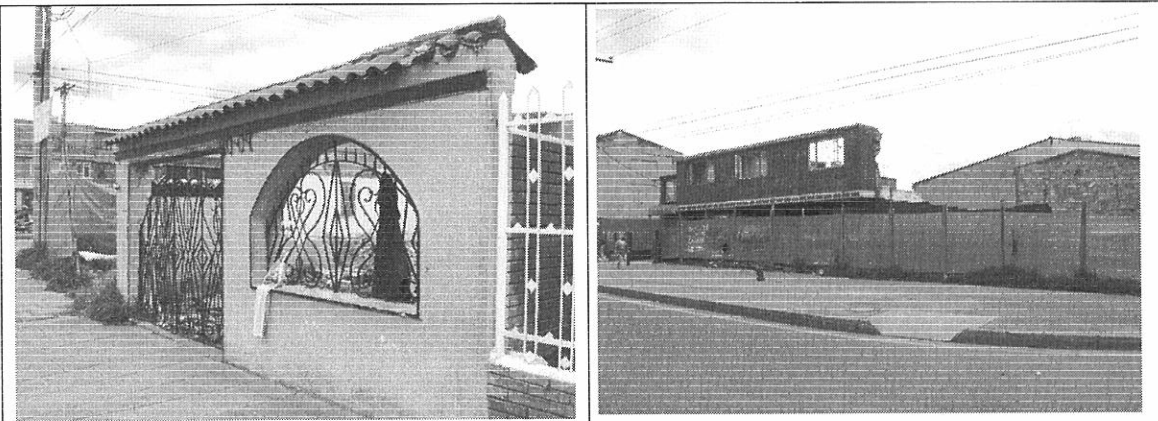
Fachada de la edificación Av. Cali # 90 - 09.
